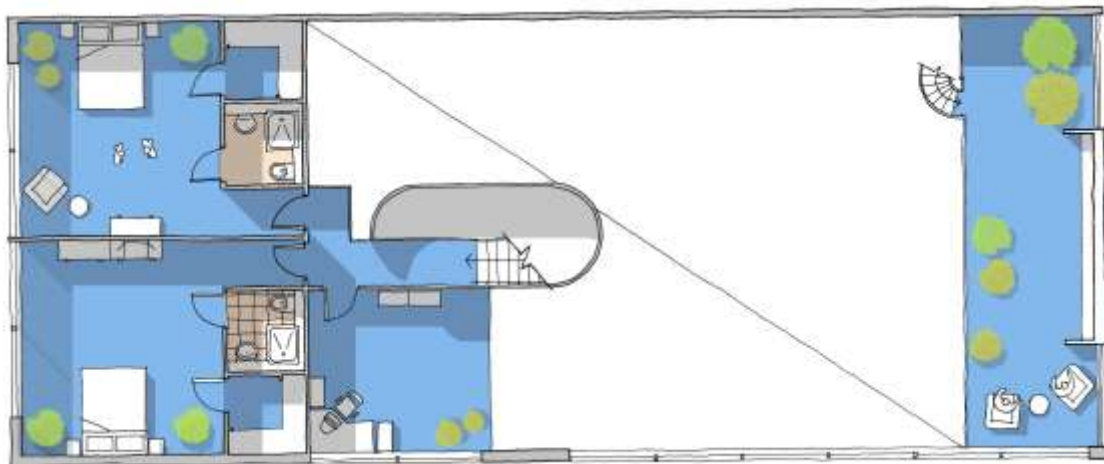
Beispiel einer offenen Grundrissplanung – Erstes Obergeschoss (Broadway Malyan Architects, London)
